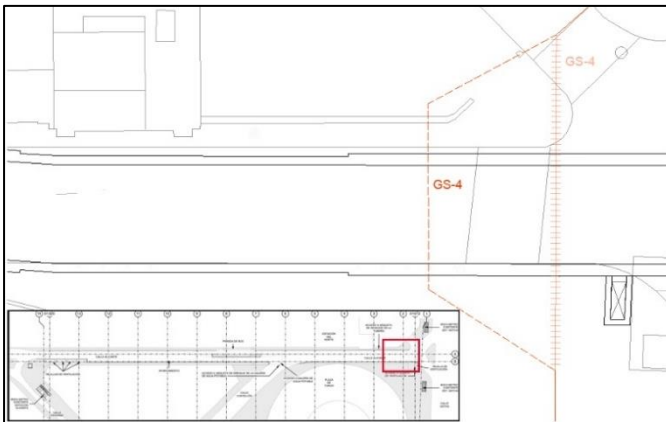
Plano de reposición GAS-BAJA-GS4-SR-CX-F7
